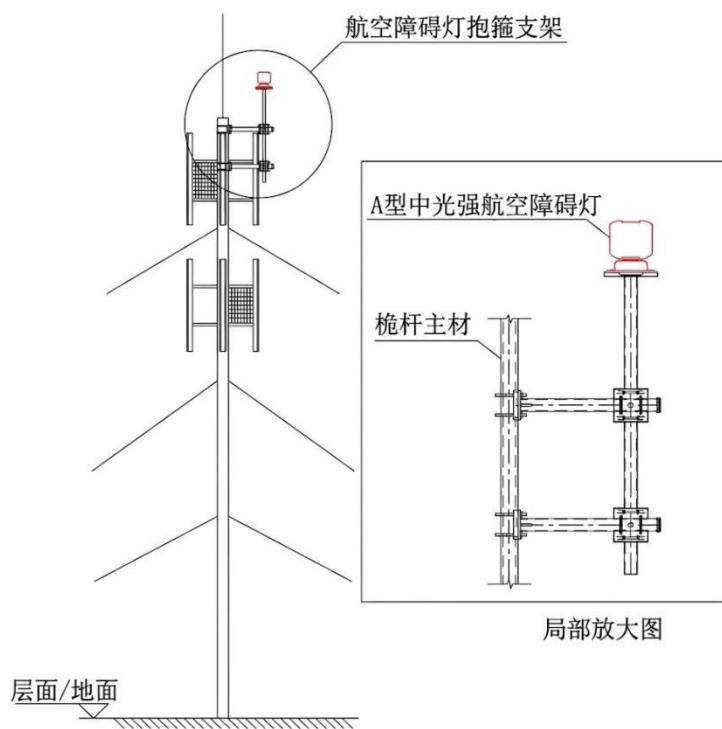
拉线桅杆设置航空障碍灯支架立面图
